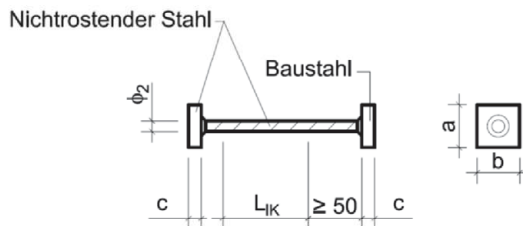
Druckelement aus Stahl mit angeschweißten Druckplatten, einseitig min. 50 mm, einseitig kleiner 50 mm einbindend (bspw. für Schöck Isokorb® Typ O)
